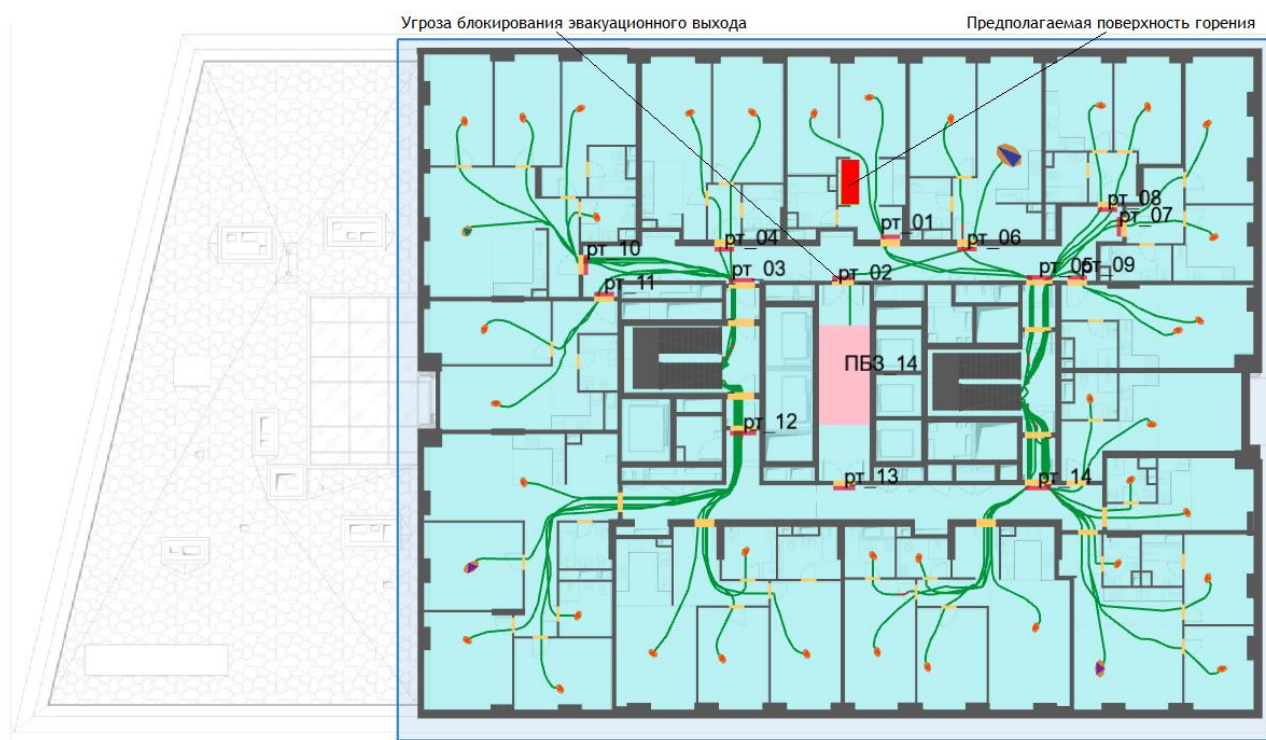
План 14-го этажа и нанесенная на него расчетная (принципиальная) схема эвакуации
